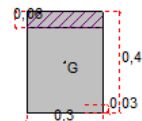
Ferrailage de la poutre principales a état ELU.
